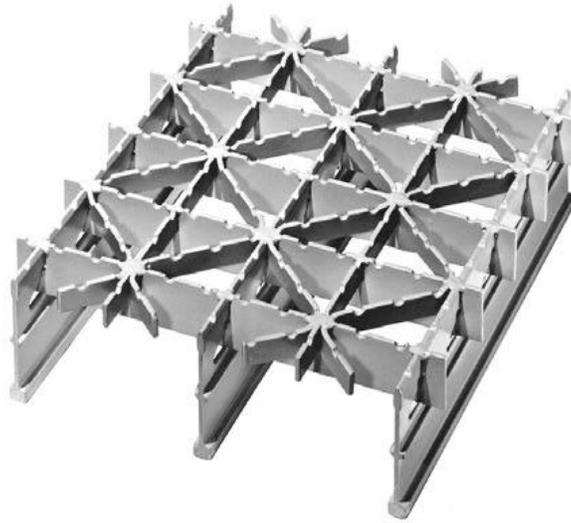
Esquema de una cubierta de parrilla de acero desnuda (Chen y Duan, 2003)
